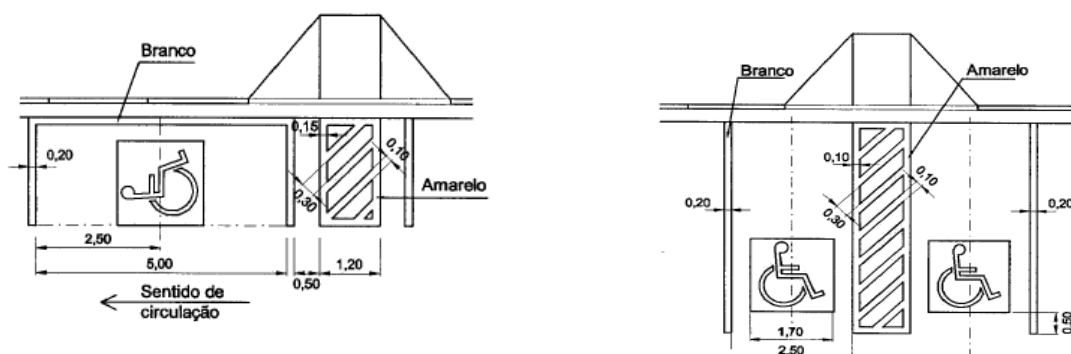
Trajetória, Detalhe e vista - Rampas para P.N.E.
